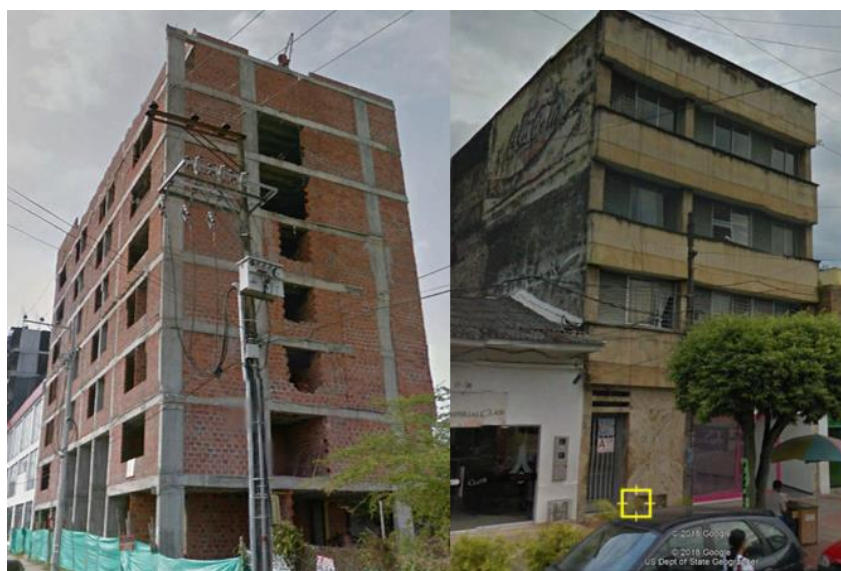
Pórticos de concreto reforzado con mampostería adosada dúctil (Izquierda), Pórticos de concreto reforzado con mampostería adosada no dúctil (Derecha)
